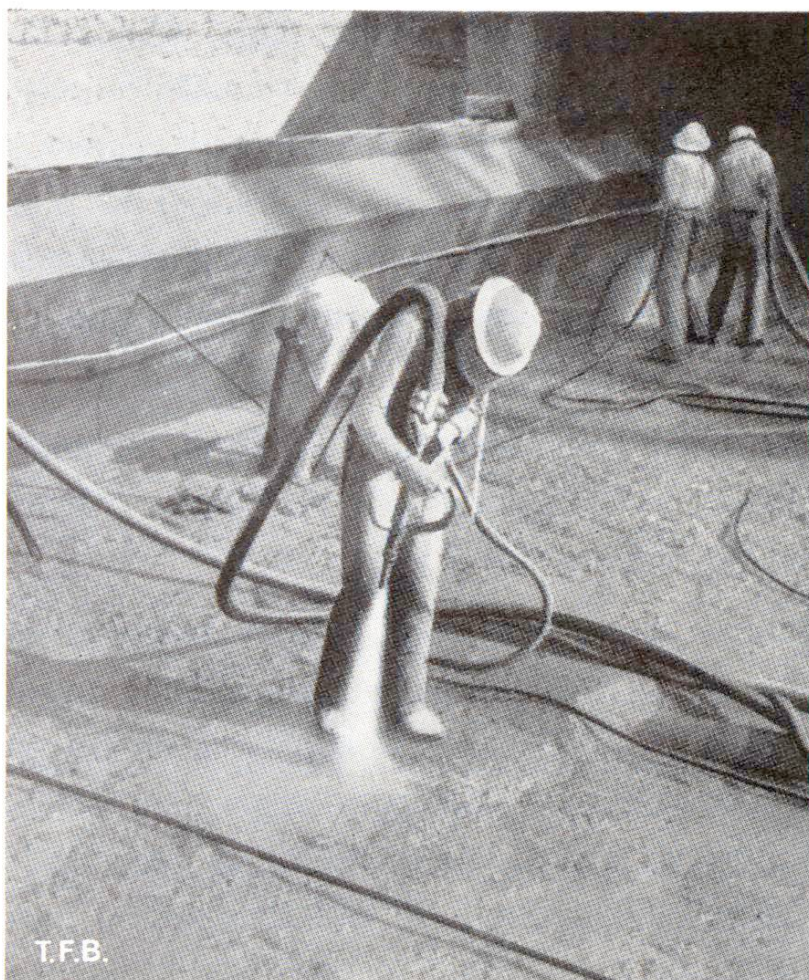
Traitement au jet de sable de la surface d'un vieux béton avant la mise en place d'une nouvelle couche
